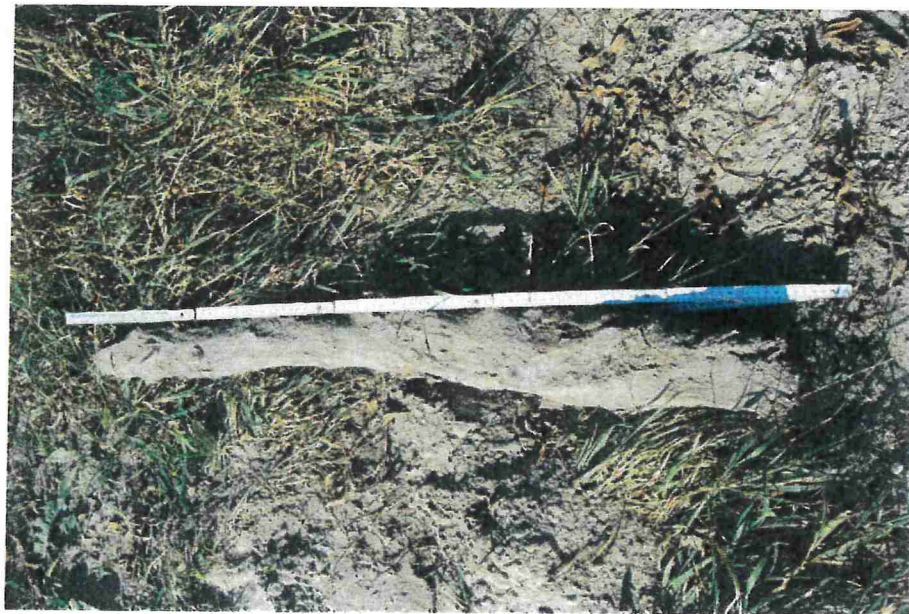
Stammnah bei Baum Nr. 7 vorgefundener, abgerissener Starkwurzelschnitt (Länge ca. 1,0 m)
